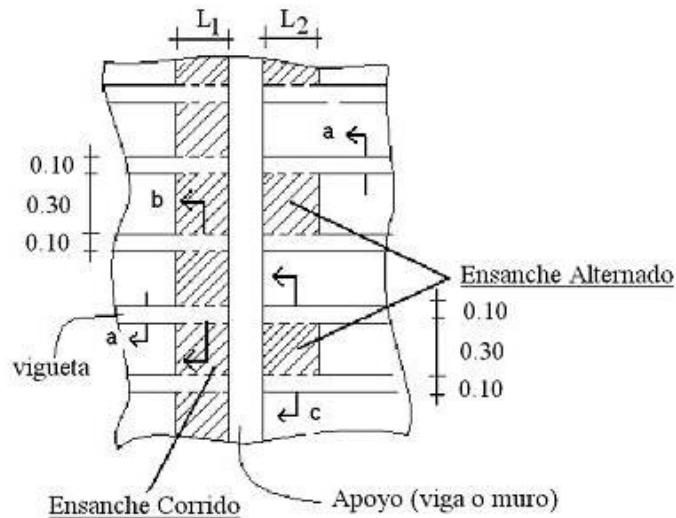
Vista en planta de los ensanches corridos y alternados.
